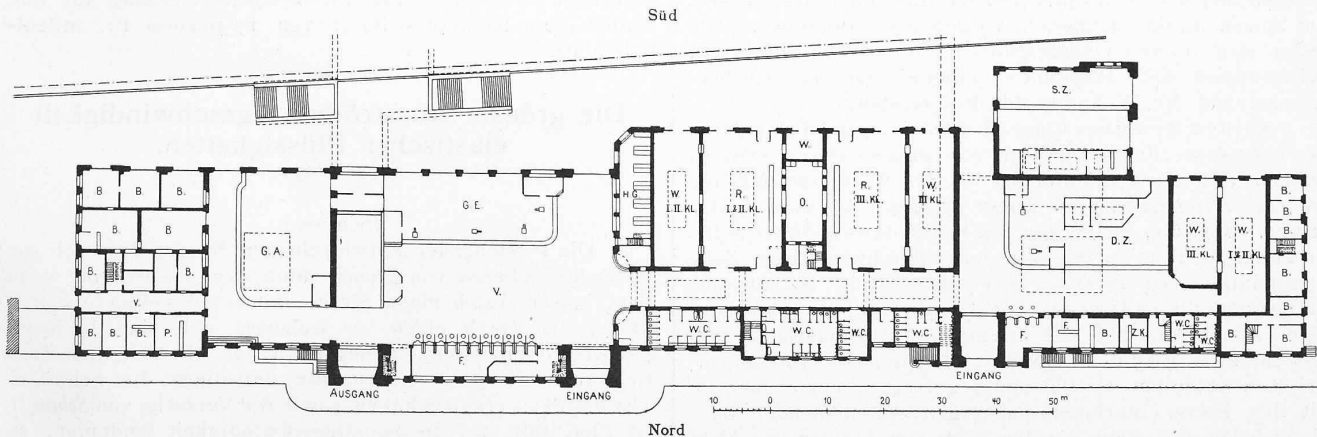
Grundriss vom Erdgeschoss. — Masstab 1:1200.
